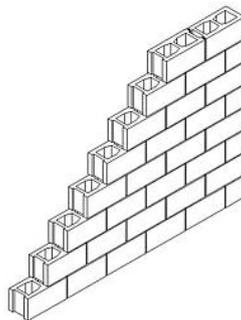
Muro de hormigón hueco. Fuente: Leceaga.
